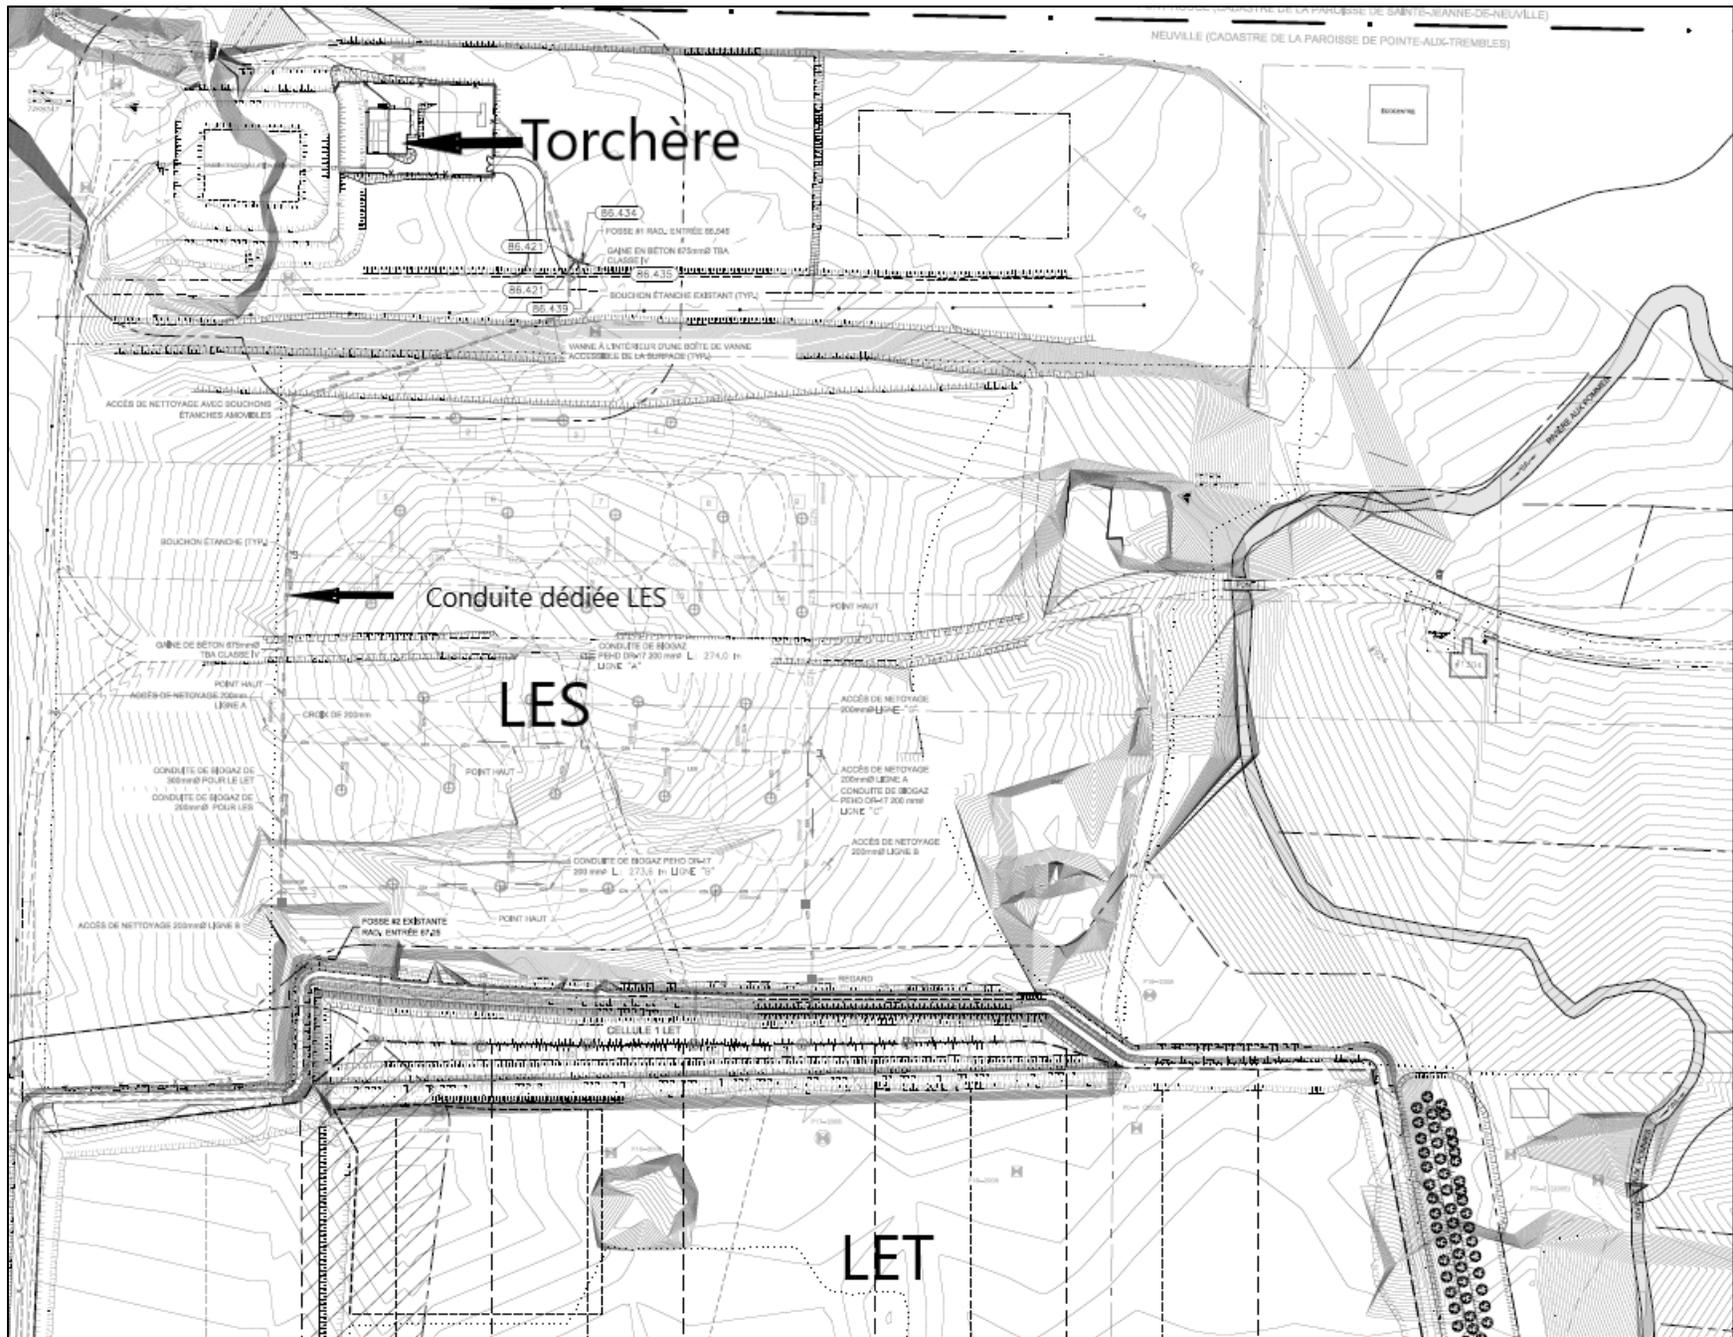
Vue en plan du lieu d'enfouissement et du système de destruction des biogaz
